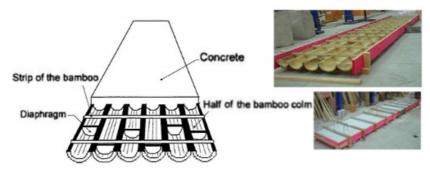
Renforcement dalle béton [Ghavami : 2004]
